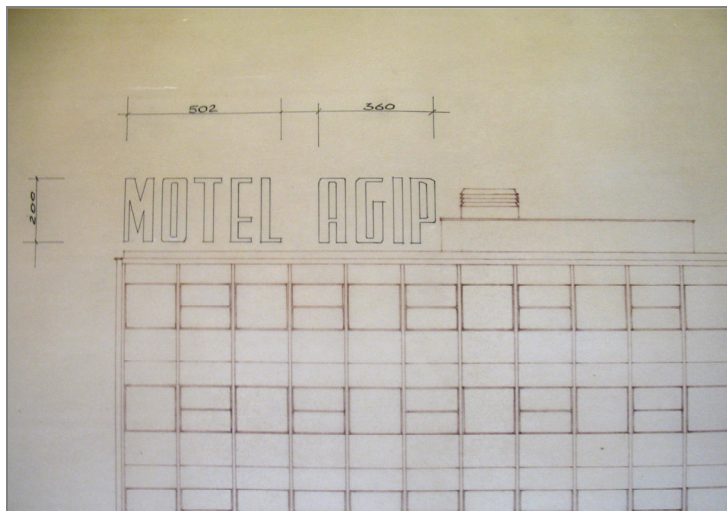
particolare prospetto verso l'autostrada (fonte CSAC – stralcio tav. 68, archivio n. 181-2)
